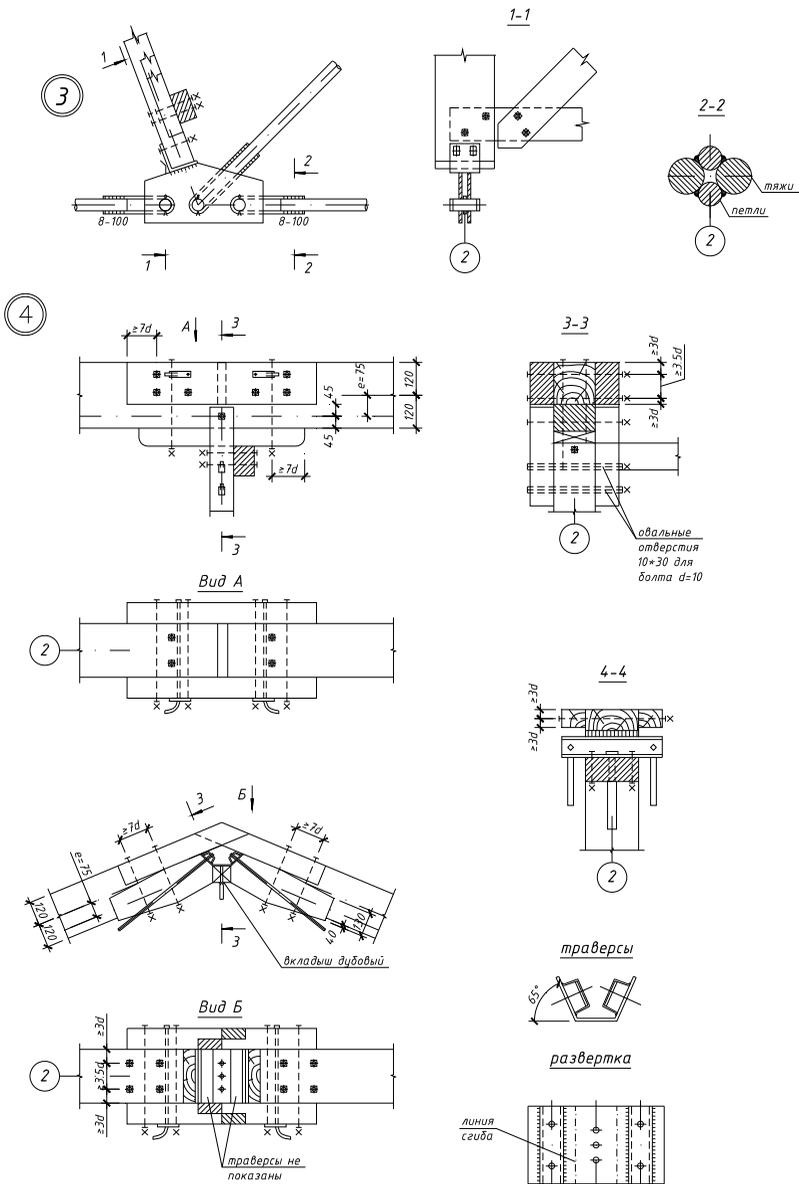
Треугольная крупнопанельная ферма с верхним поясом из цельных блоков (окончание):
